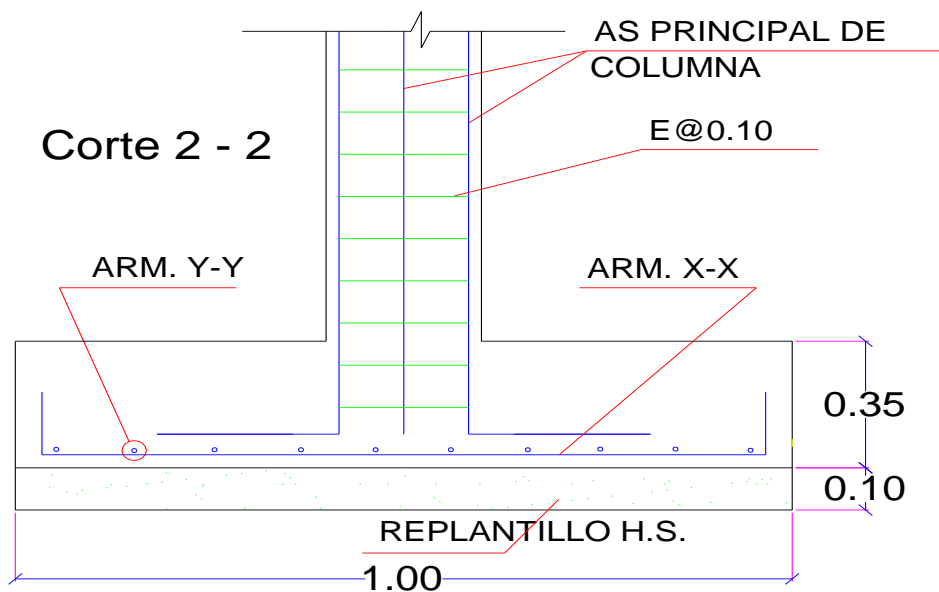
Se describe el corte 2 – 2 cimentación tipo, ubicación del acero de refuerzo y sus dimensiones.
